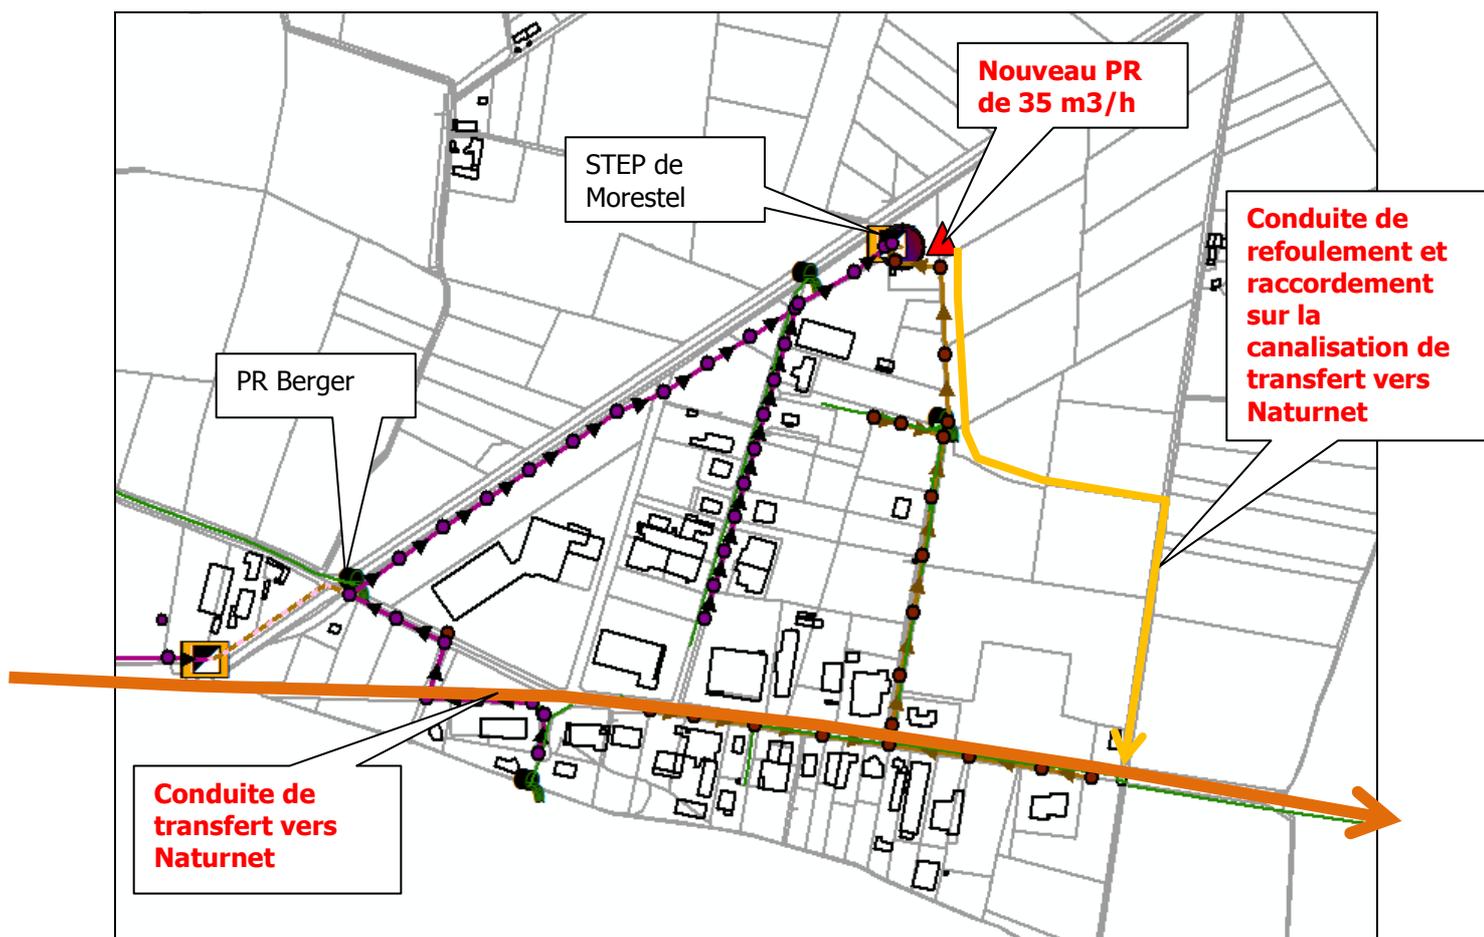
RESTRUCTURATION SUR LE SECTEUR OUEST - LYCEE
